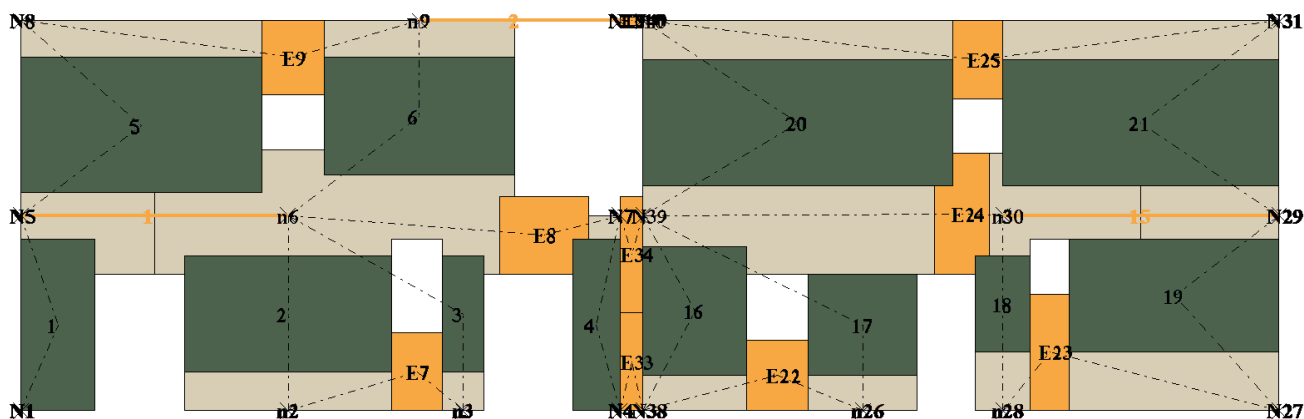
Prospetto Parete 1 - Modello Scollegato
